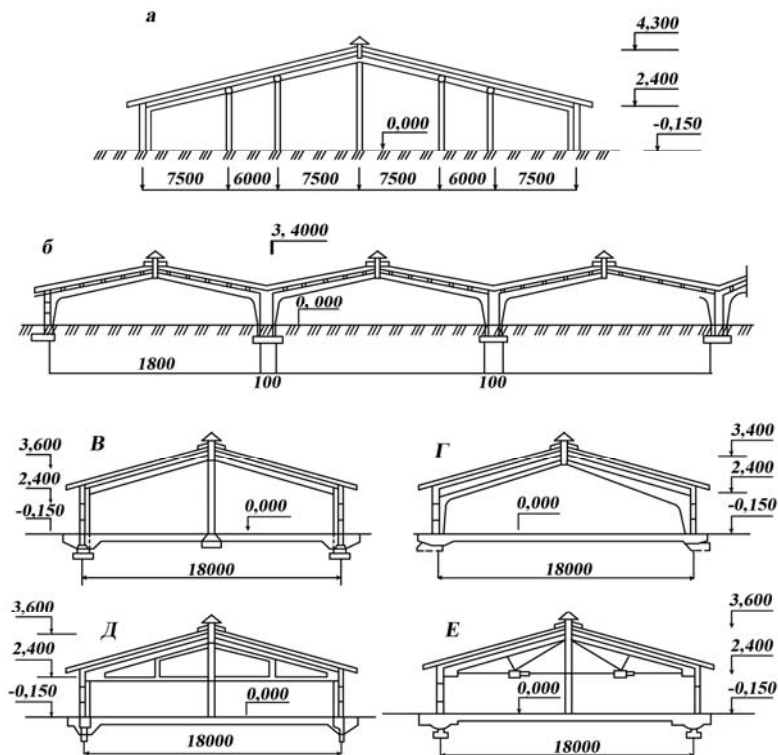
Будівлі свинарників із уніфікованих збірних залізобетонних конструкцій:
